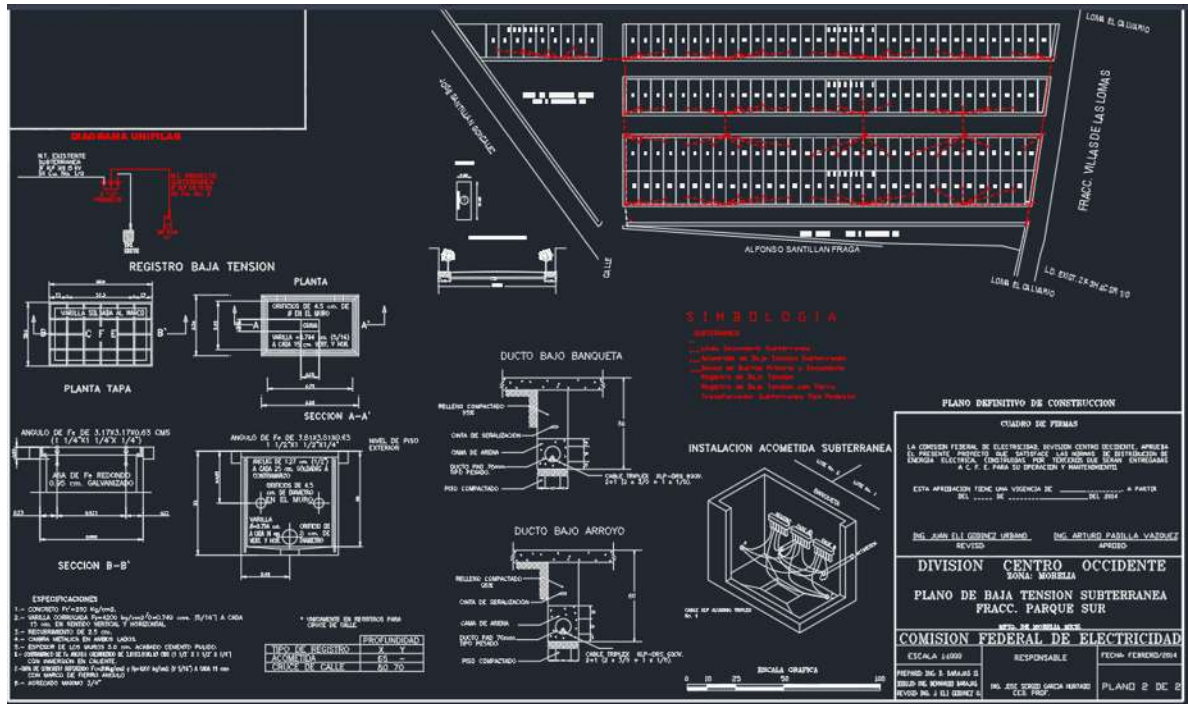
ELEBORACIÓN PLANO BAJA TENSION.
